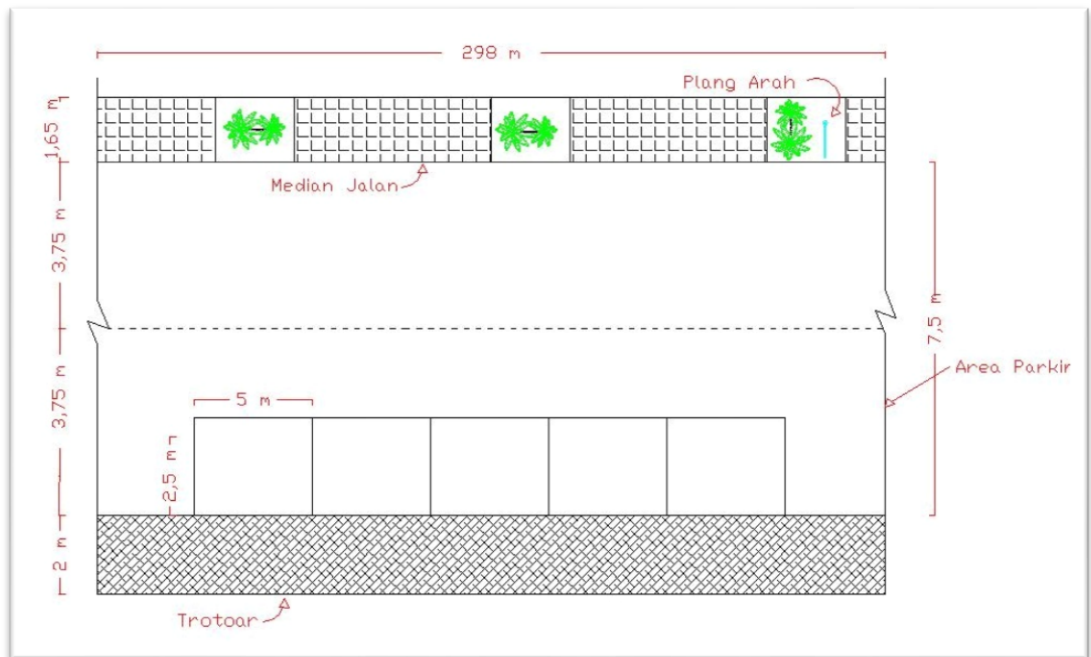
panjang dan lebar jalan eksisting lokasi studi.
